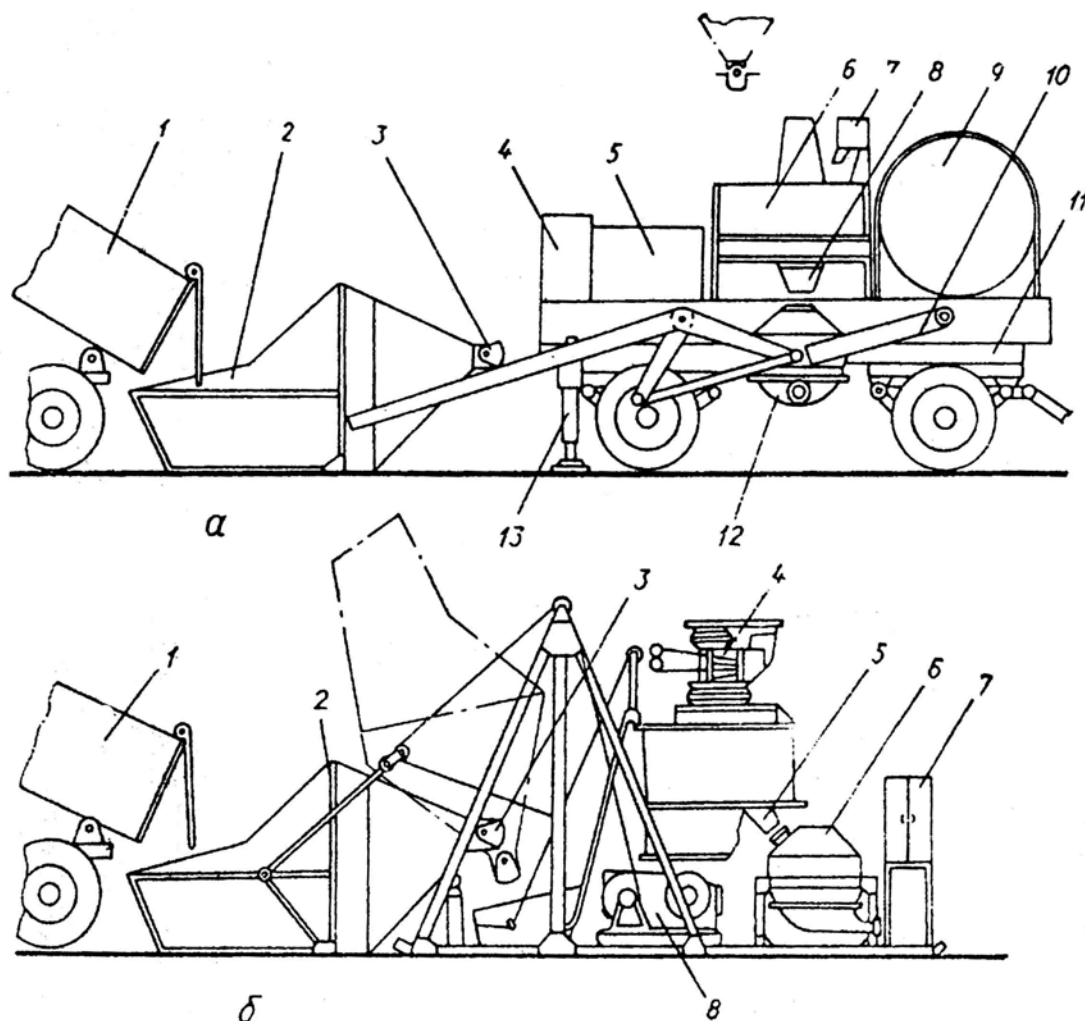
Компонувальні схеми пересувного бетоноукладача при улаштуванні конструкцій підлоги:
